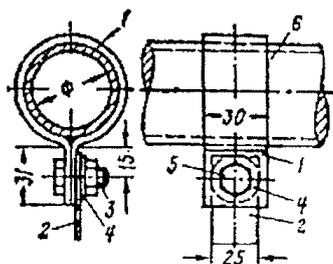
Присоединение заземляющего отвода к трубопроводу с помощью хомута: 1 - хомут 1,9х30 (внутренний диаметр хомута соответствует наружному диаметру трубопровода); 2 - заземляющий отвод 2,2х25; 3 - болт; 4 - шайба; 5 - гайка; 6 - трубопровод
